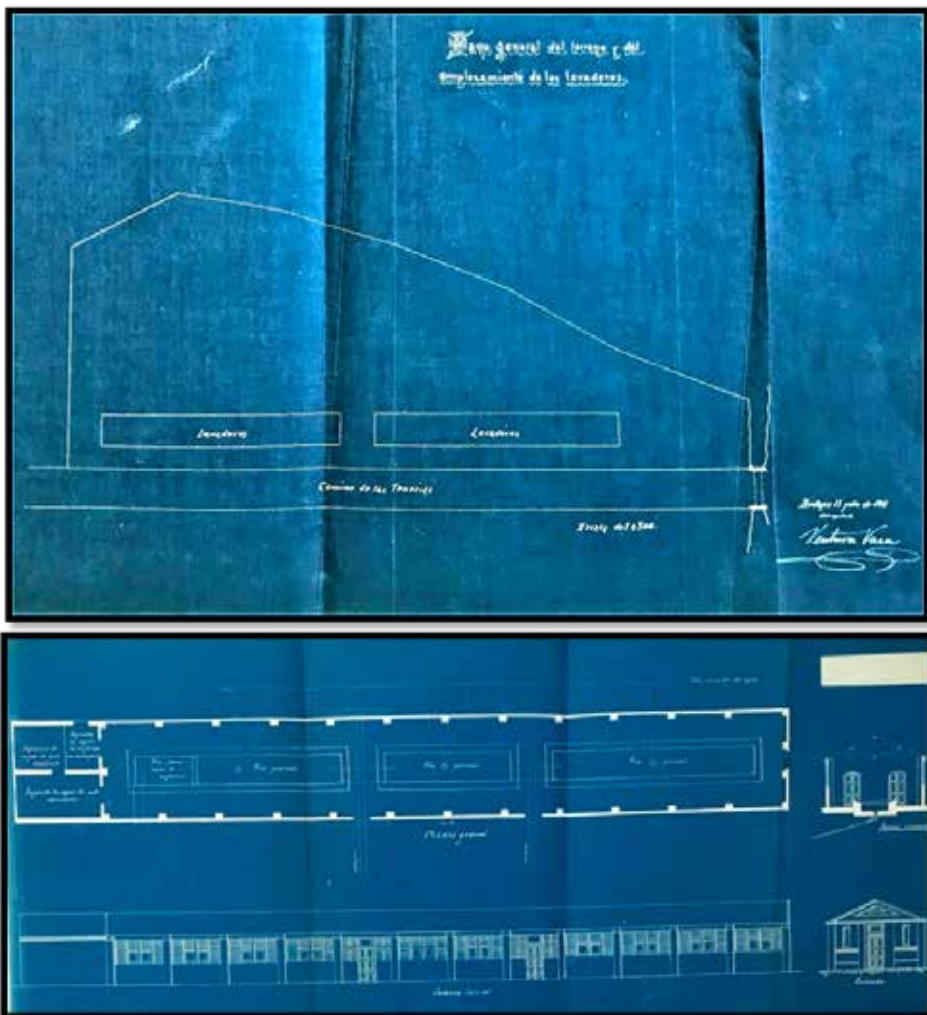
y 345. Emplazamiento y plano proyectado para el levantamiento de un lavadero municipal según se expresa en "el camino de las tenerías". Fuente: Sección de vías y obras año 1912. AHMB.
